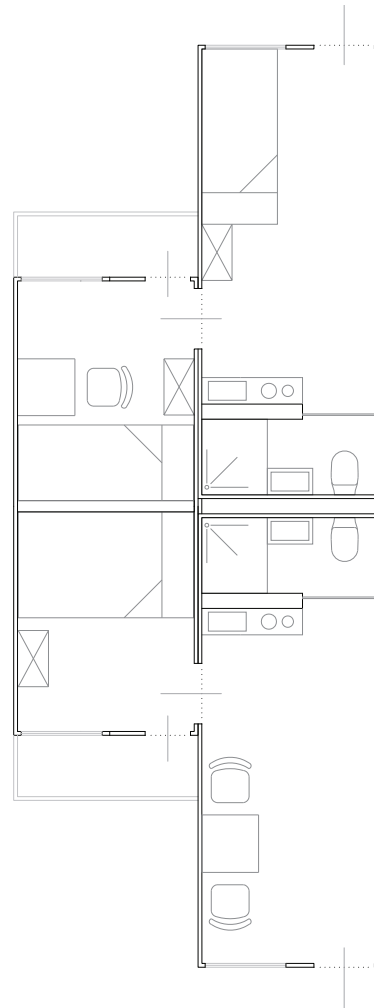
Grundriss Modul 40 WO 2A und 2B
